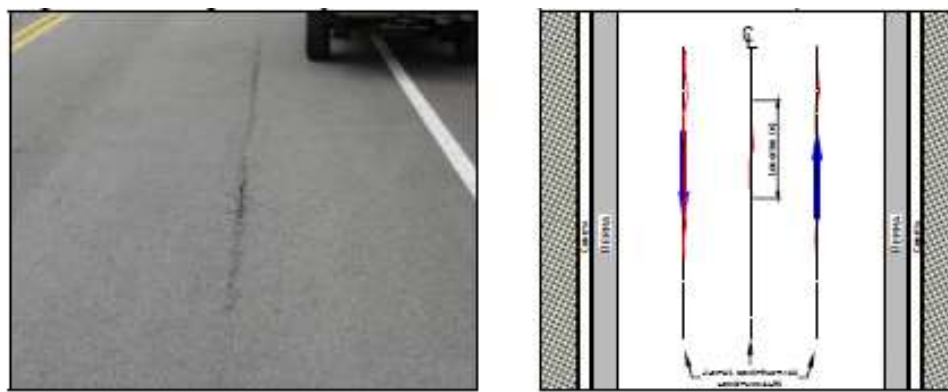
Fisura longitudinal en junta de construcción (FCL).
